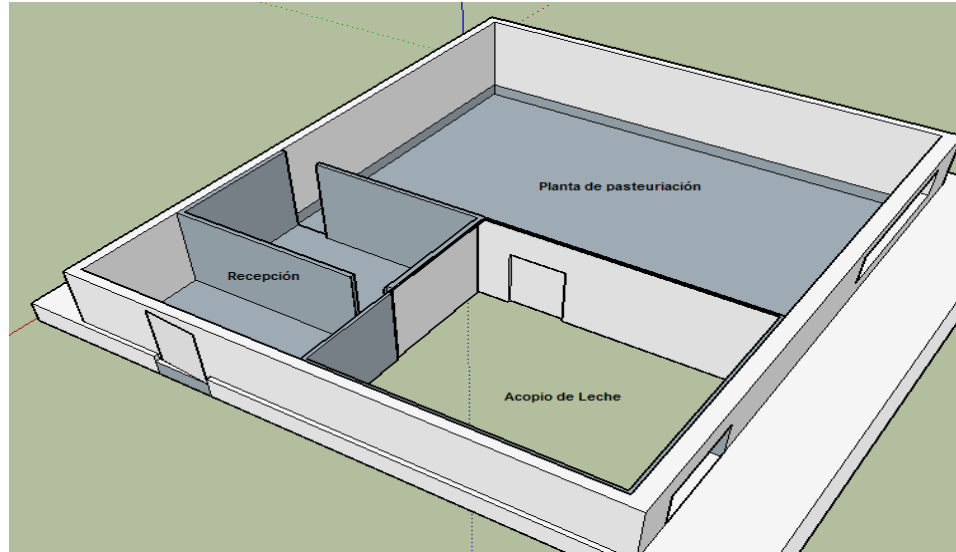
Distribución física de Estructura de la planta. Fuente: Autores.
